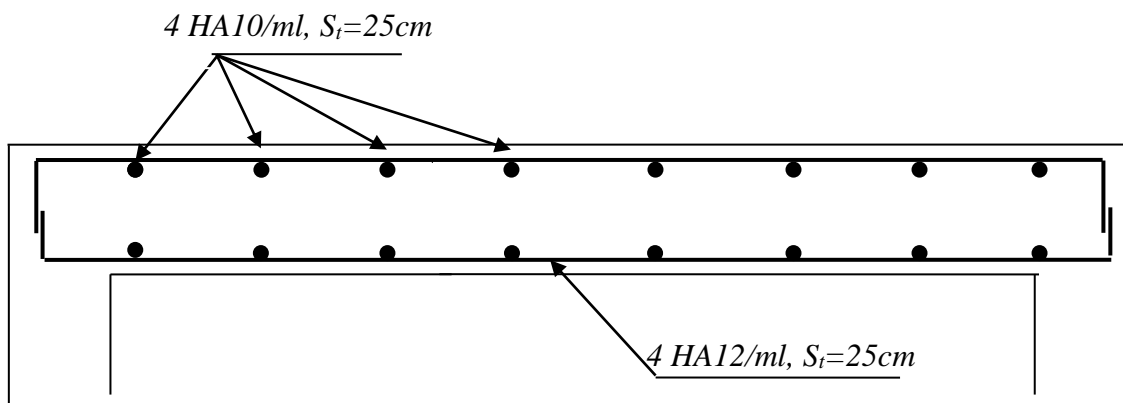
Plan de ferrailage de la salle machine suivant x-x.
